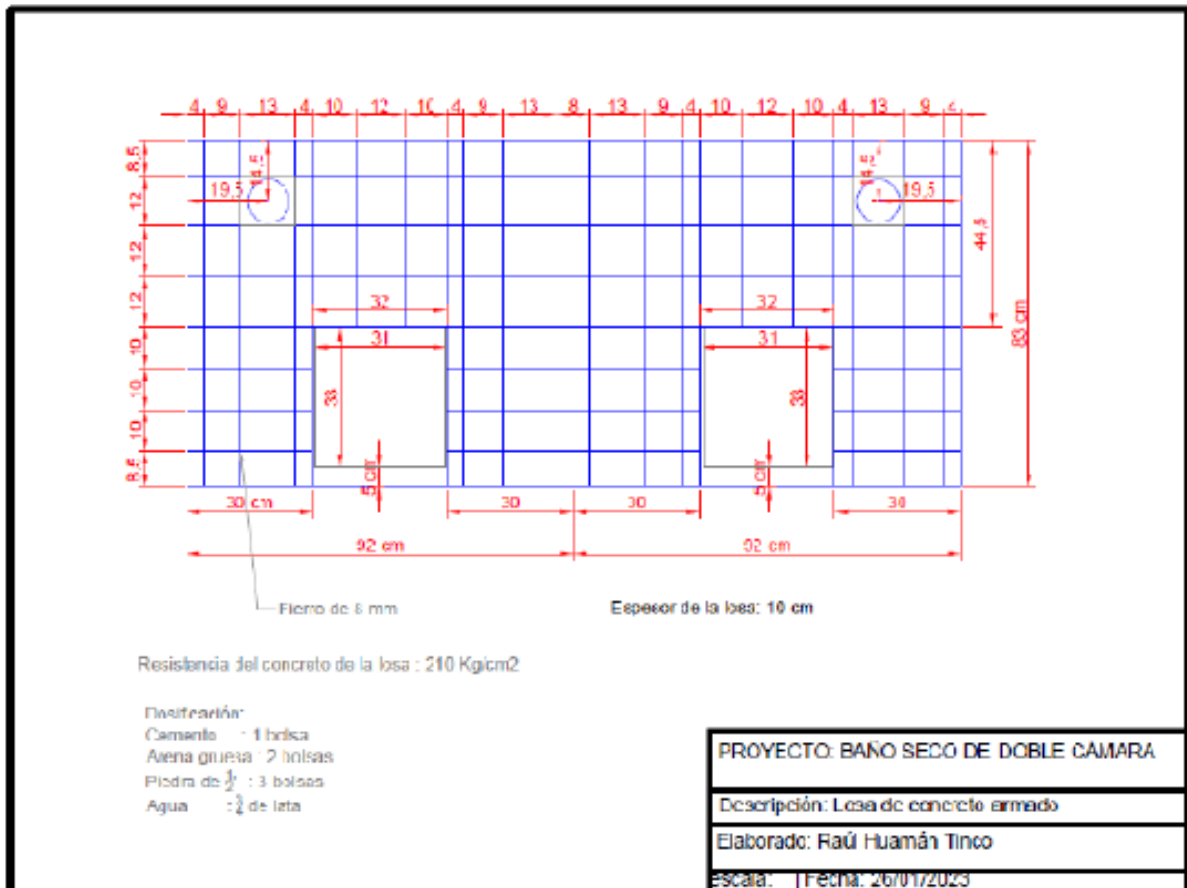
Planos estructurales de las tapas en las cámaras de deshidratación.
